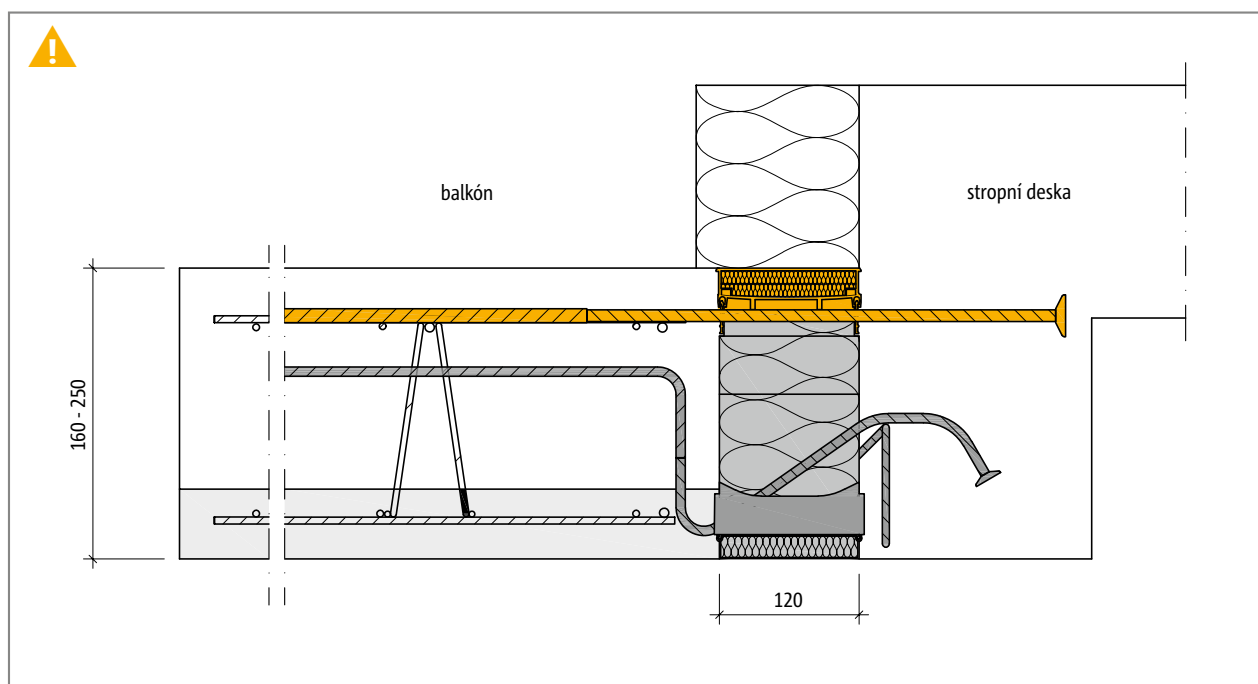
Schöck Isokorb® XT typ KL-O-F: Balkón z filigránových desek, nadvýšený oproti stropní desce
